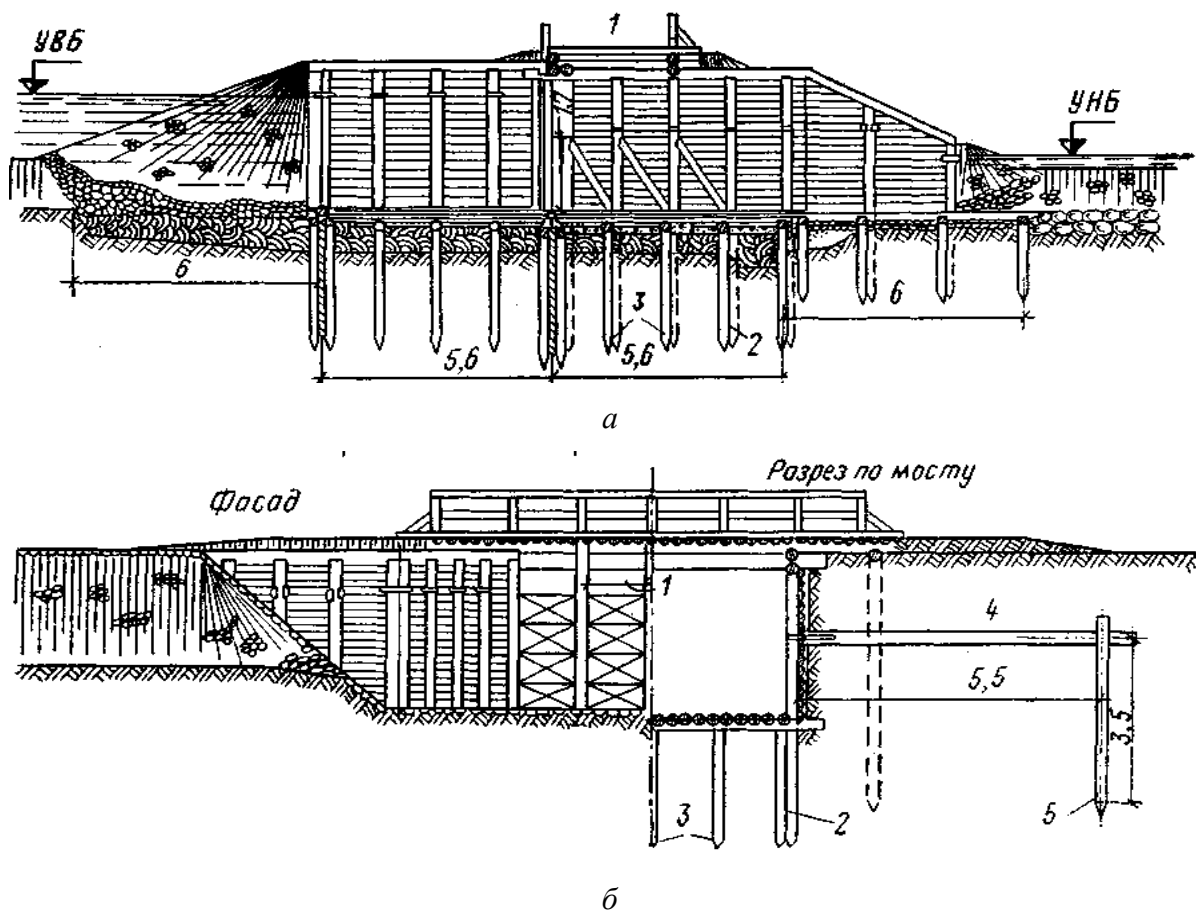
Свайно-обшивная плотина: *а* – продольный разрез; *б* – поперечный разрез; 1 – служебный мост; 2 – стенные сваи; 3 – сваи флутбета; 4 – анкерная схватка; 5 – анкерная свая
